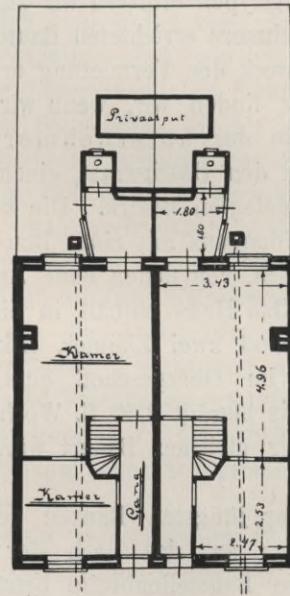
Kleines Einfamilien-Reihenhaus, Unternehmerbau. Utrecht. Baujahr 1913.
